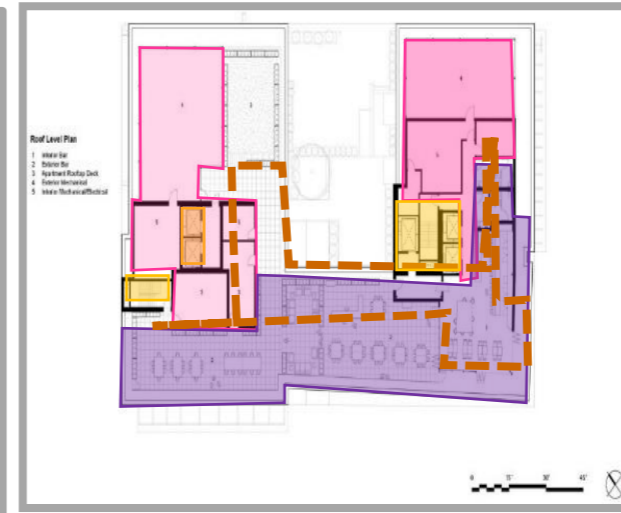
Plan de toiture traité par l'auteur Source: Amush.org
